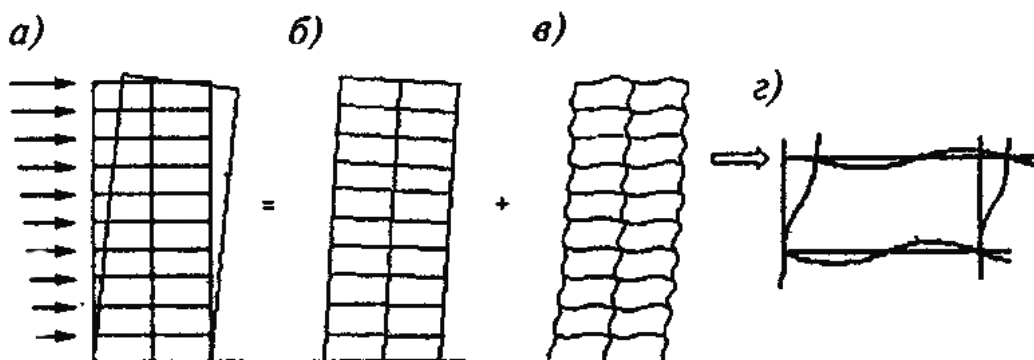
Схемы деформирования каркаса с разными узлами при действии горизонтальной нагрузки:
